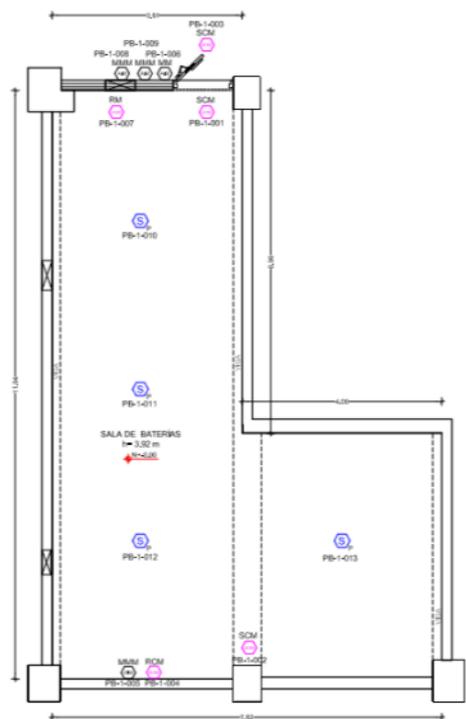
Plano de sensores y pulsadores de sala de Baterías
